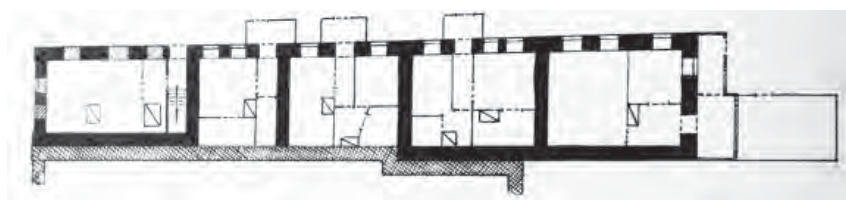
План каменного флигеля пристроенного к мечете (на схеме примыкание к стене мечети)
